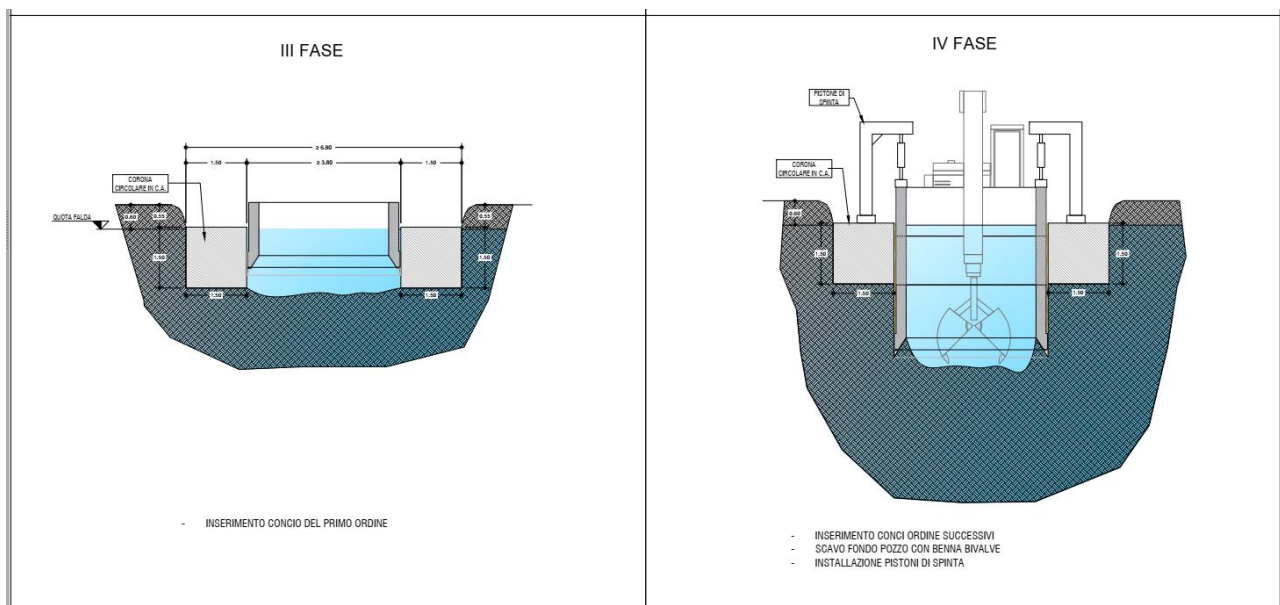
C : Schema tecnico realizzazione pozzo autoaffondante
